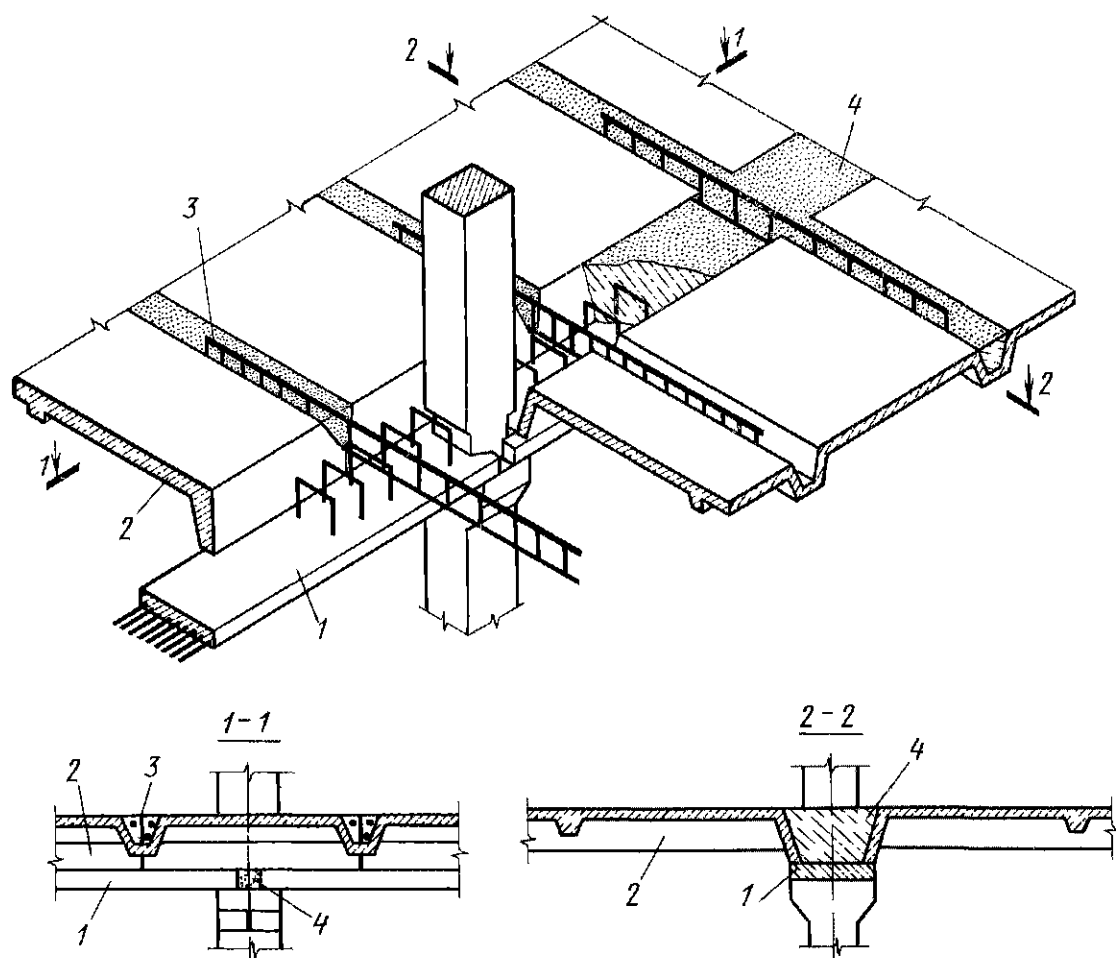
Балочное сборно-монолитное перекрытие из тонкостенных элементов
